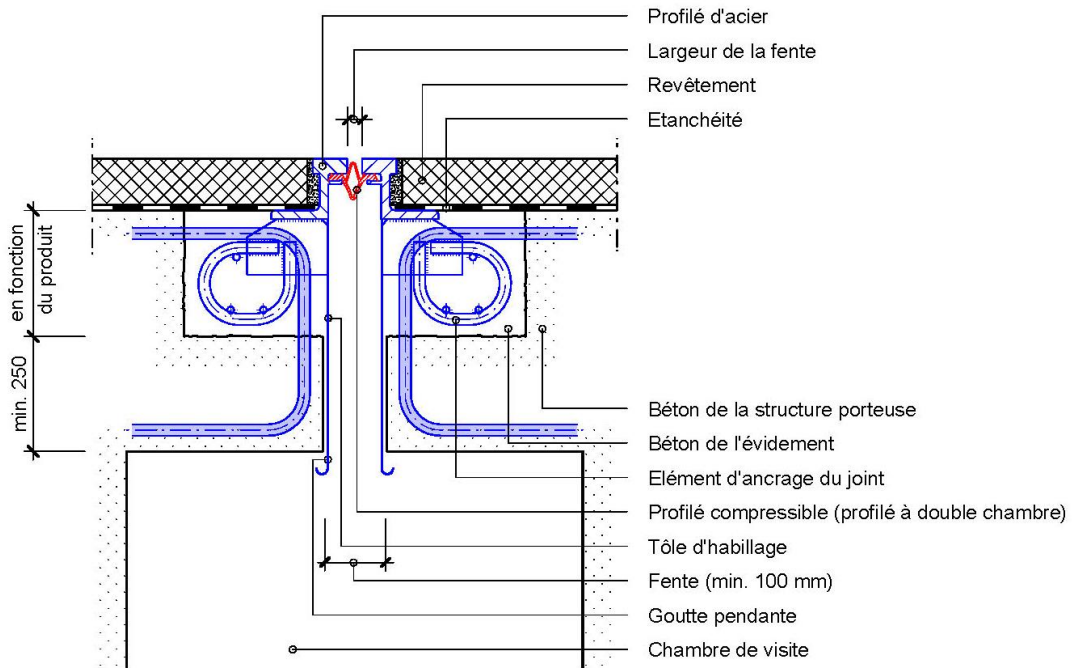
Coupe schématique d'un joint de chaussée à profilé compressible.
